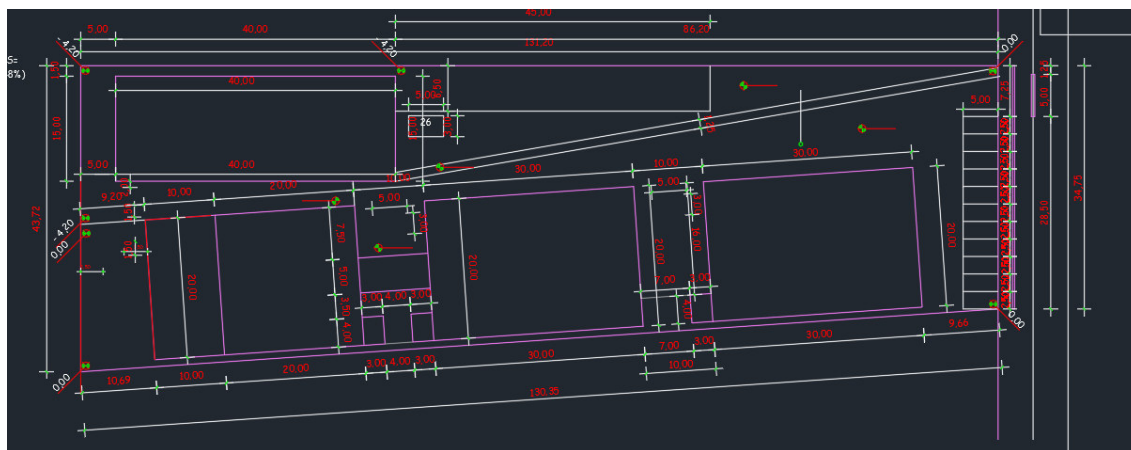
Planta demonstrando as vagas de estacionamento de veículos leves na área da empresa.
